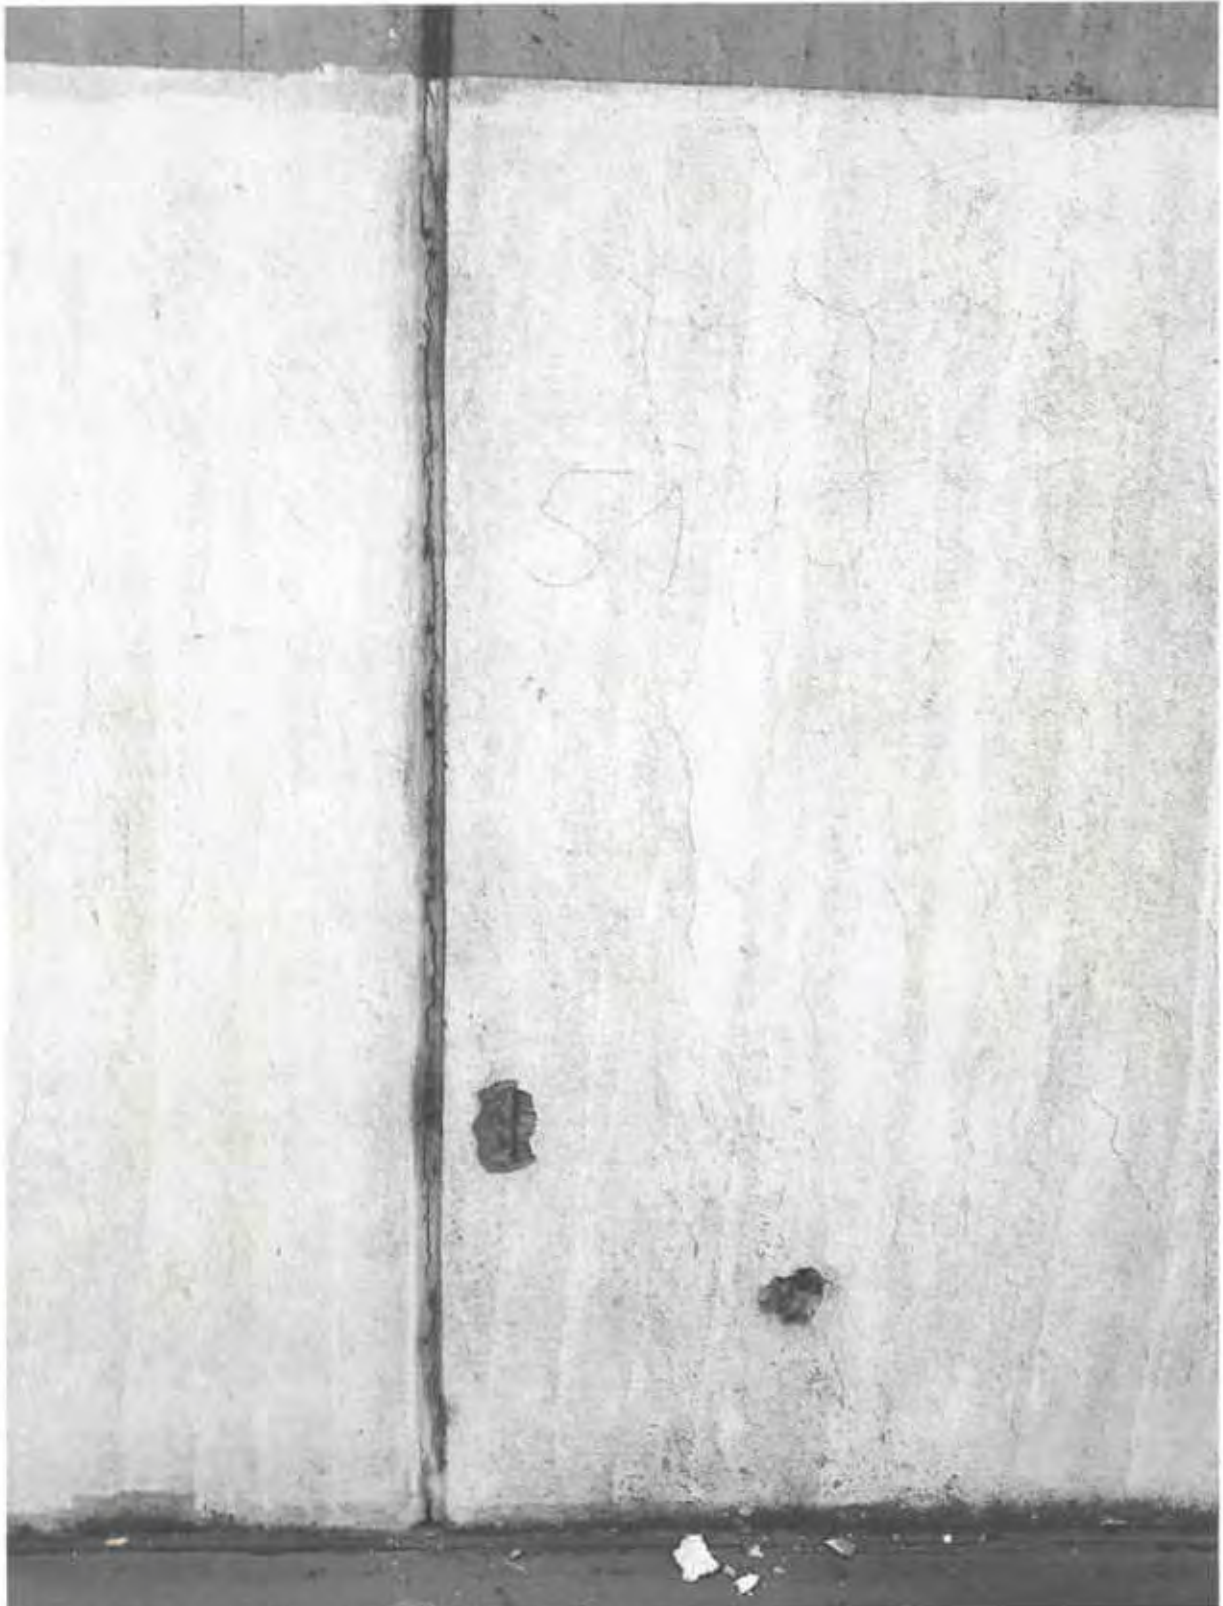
Achse B, Block 52: Altanstrich, Beschichtung / Sichtbeton
